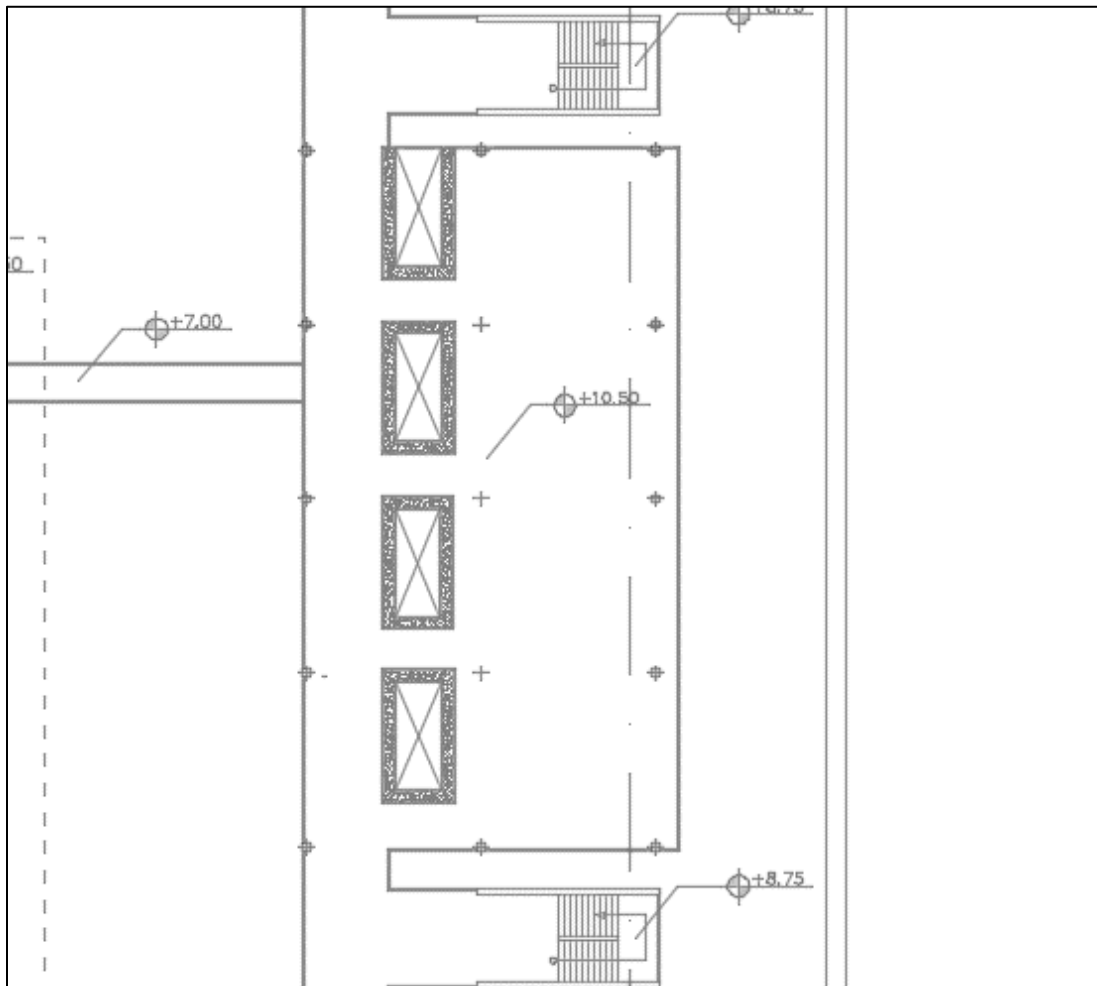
Planta Terraza Módulo de Aulas II. Fuente: Propia autoría. (2018).
